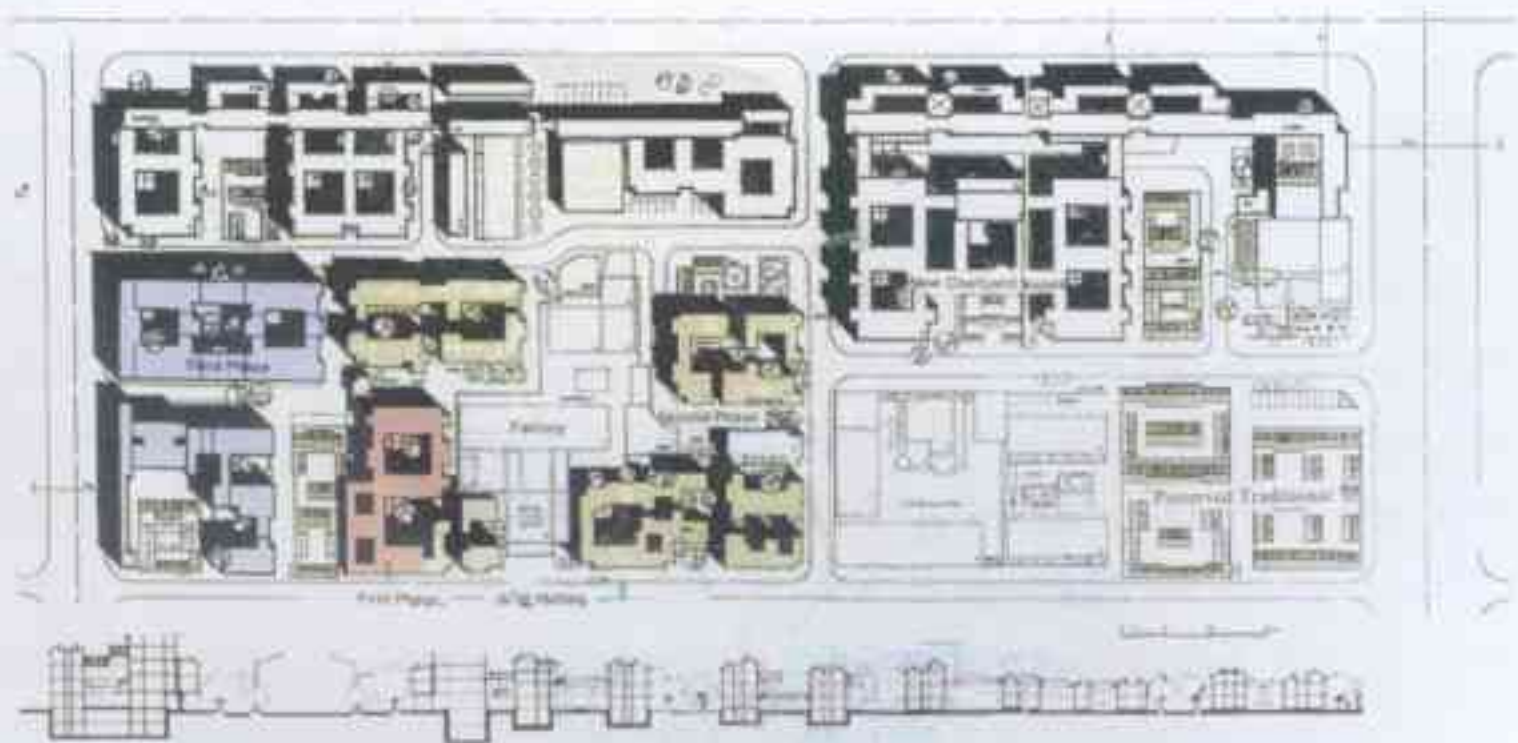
菊儿胡同新四合院住宅区平面
